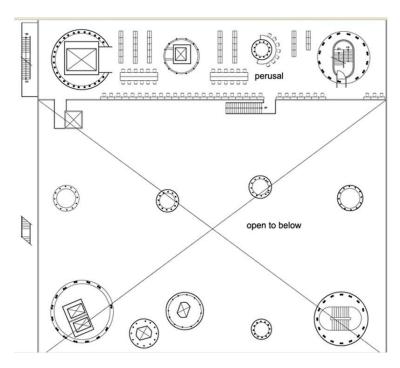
Planta 4to. Nivel, Mediateca de Sendai.
